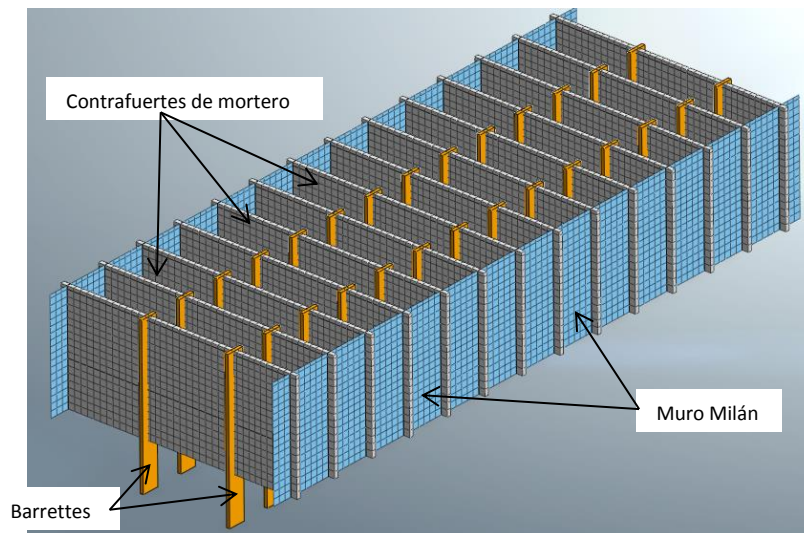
Arreglo tridimensional de Muro Milán, Contrafuertes y Barretes.
